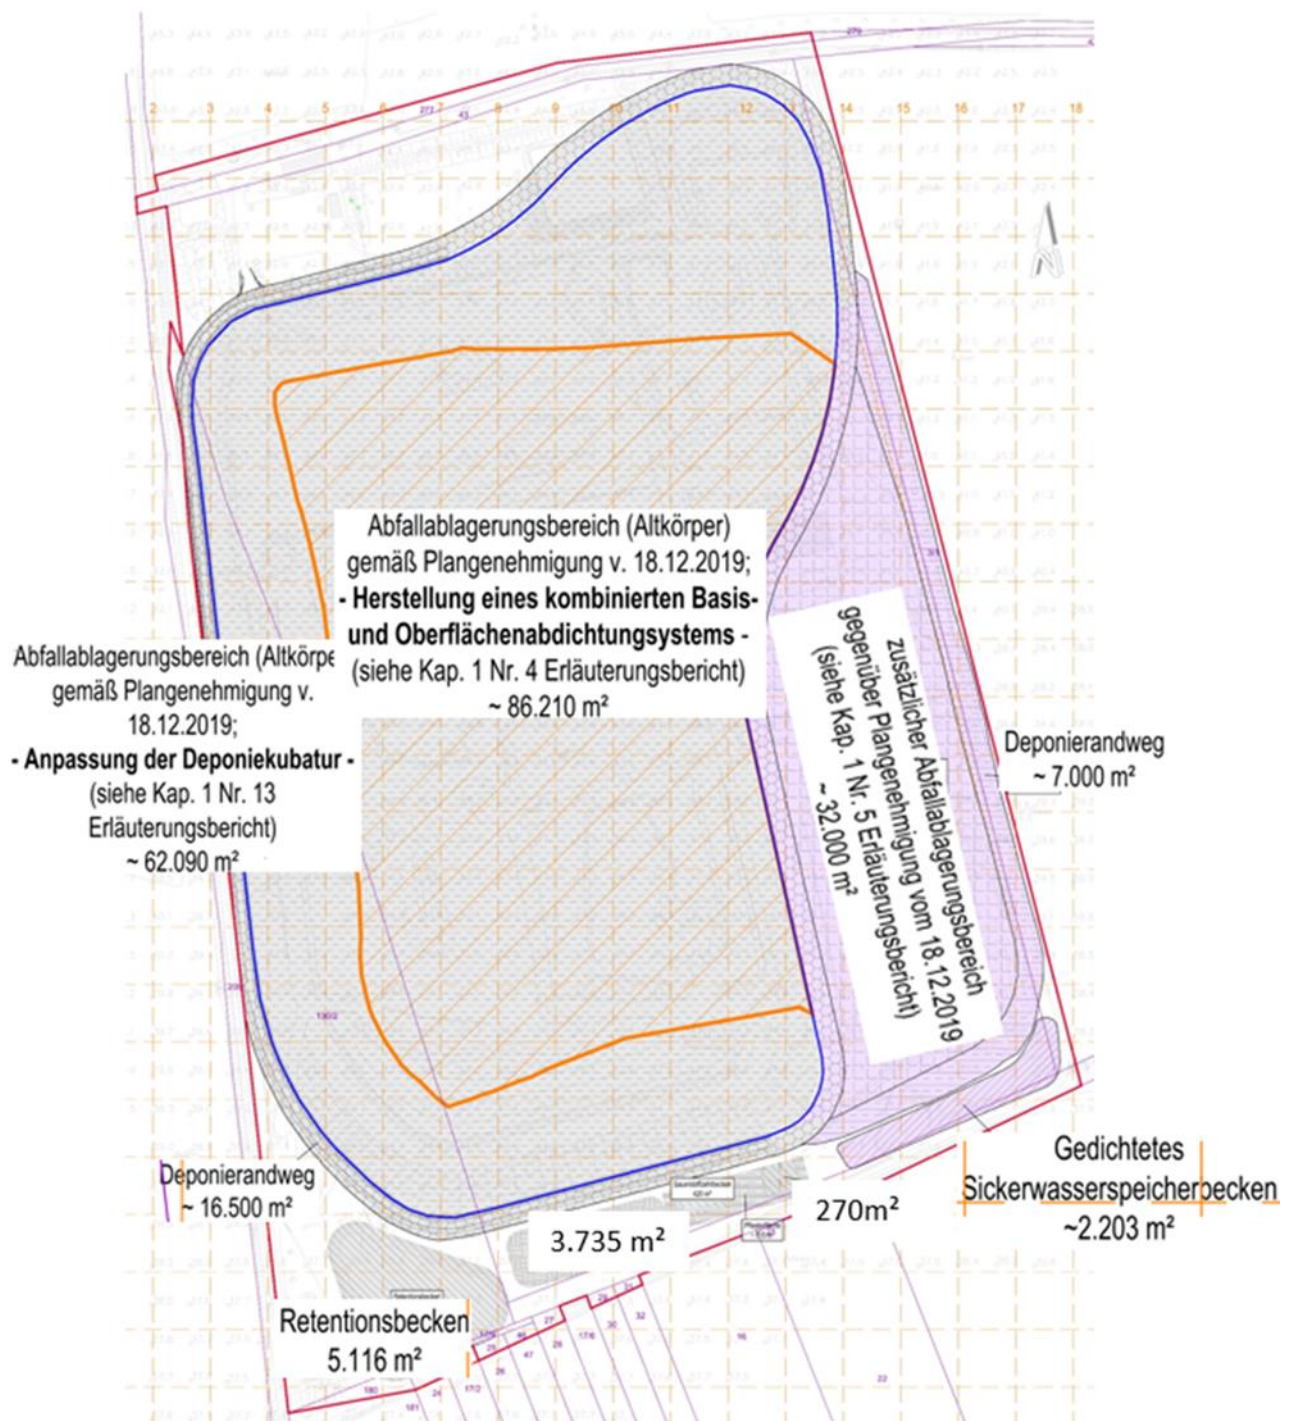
Lageplan Deponie mit zusätzlicher Flächeninanspruchnahme
